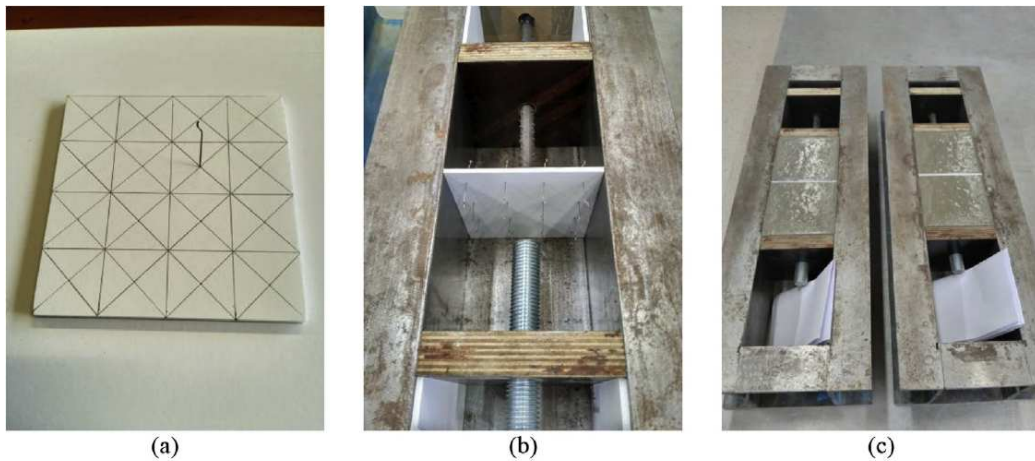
Producción de probetas de ensayo: (a) colocación de las fibras en el cartón-espuma; (b) posicionamiento del cartón-espuma en el molde; (c) colocación del hormigón en el molde. (Simões et al., 2017)
